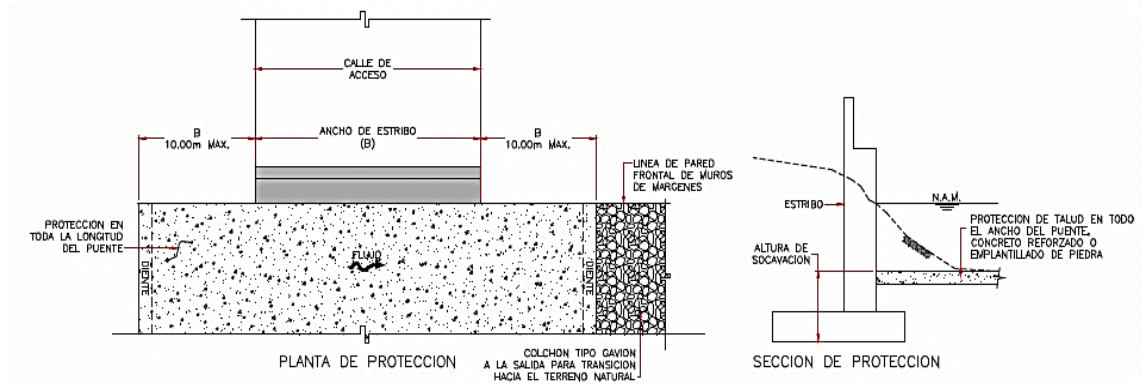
Protección para estribos en todo el cauce bajo el puente.
